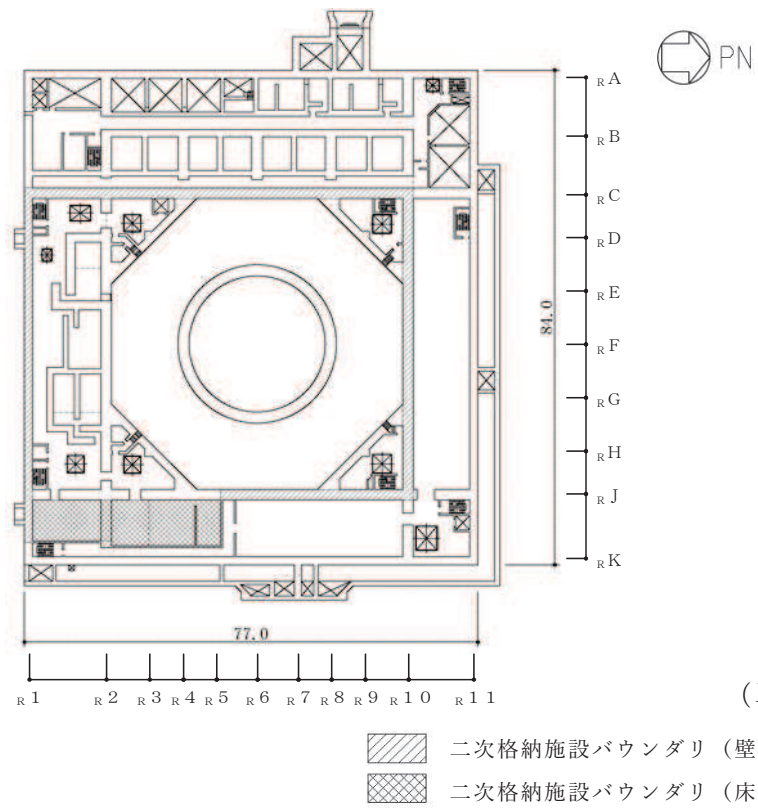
原子炉建屋原子炉棟（二次格納施設）の範囲の平面図
